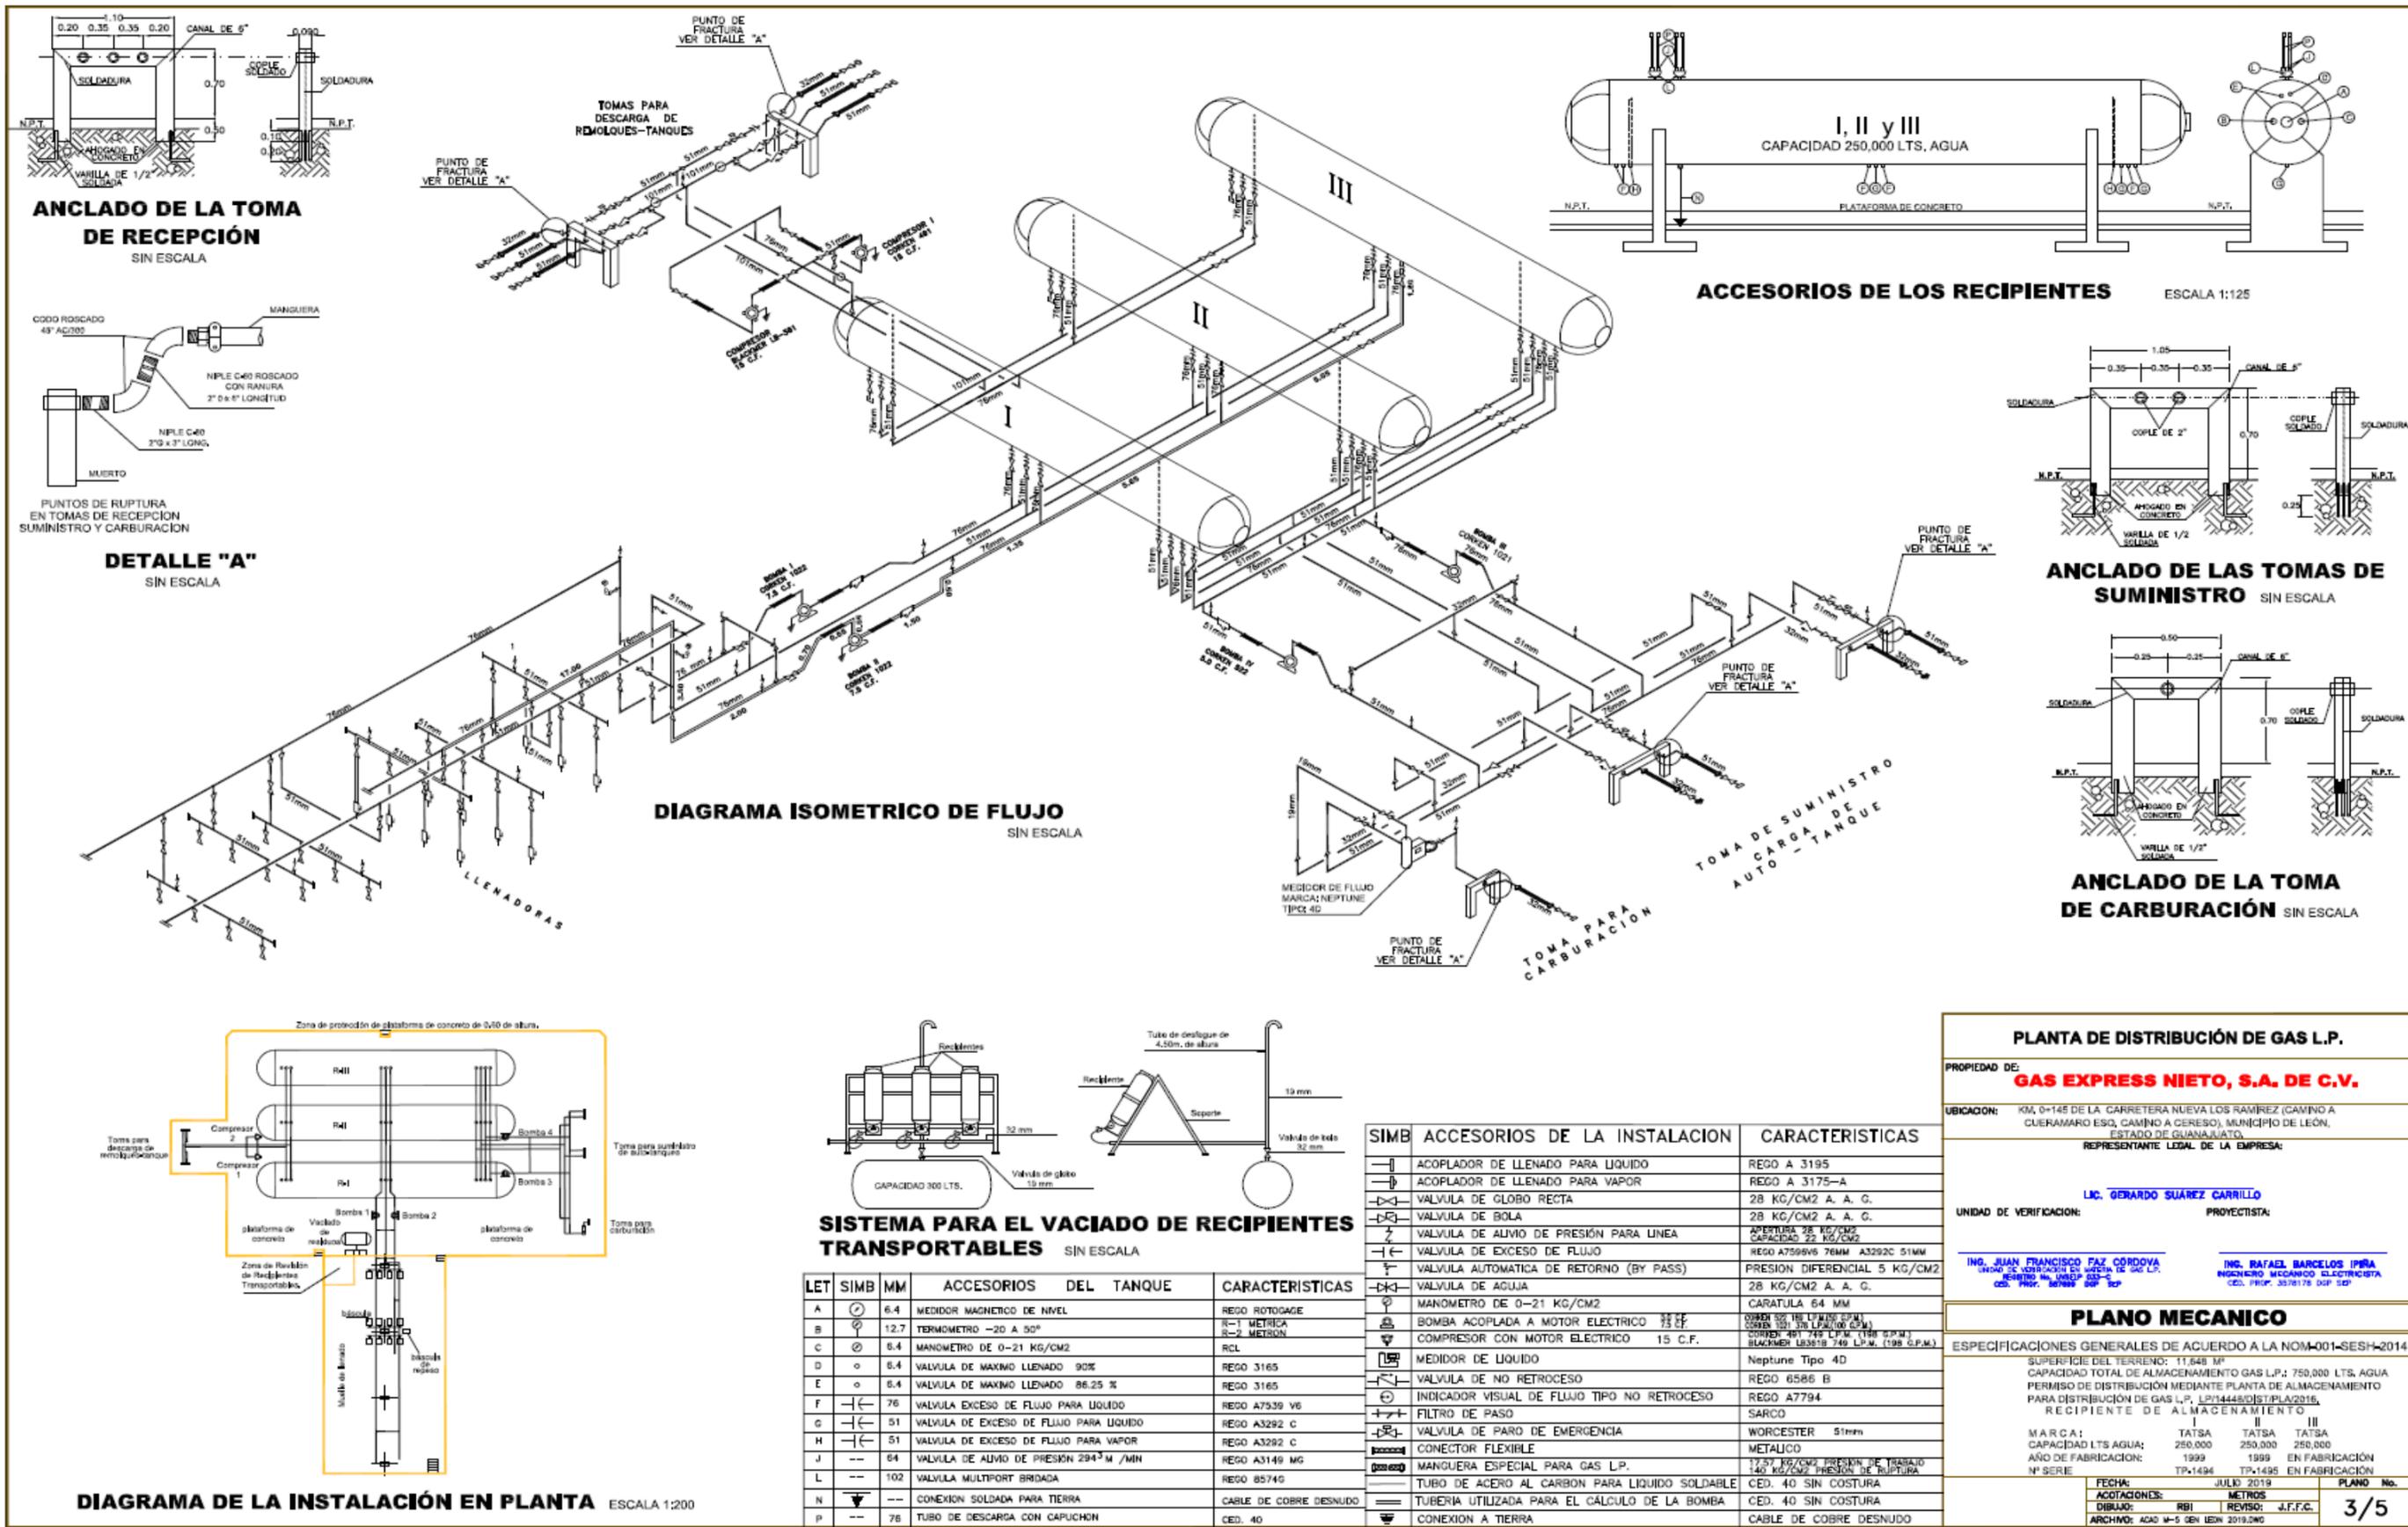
Plano mecánico de la planta de almacenamiento incluyendo el tanque proyectado de 250,000 litros.
